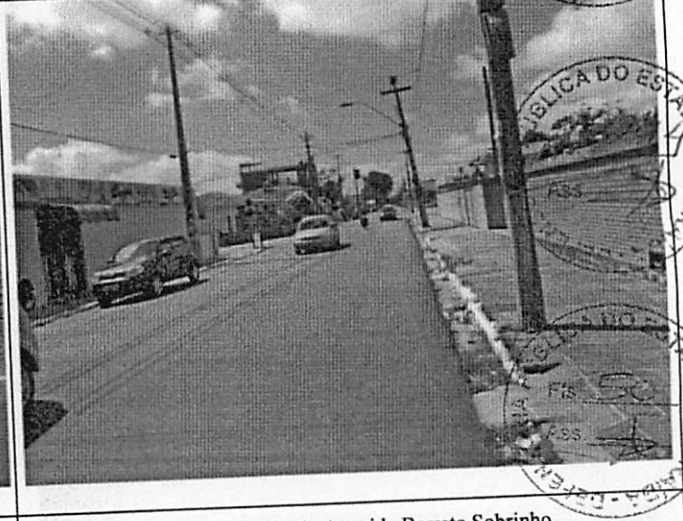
Detalhe da Avenida Barreto Sobrinho
